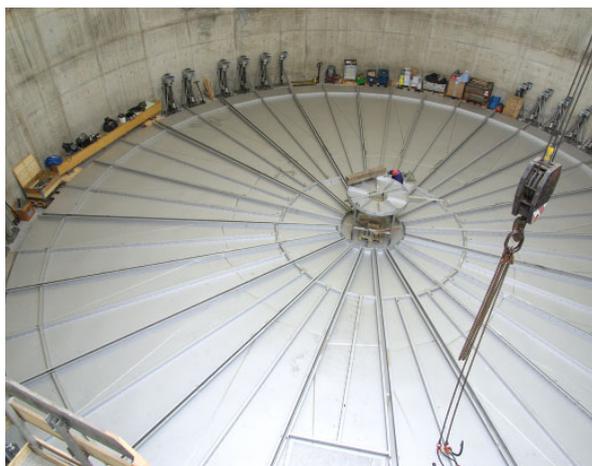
Zusammenbau des Segmentdaches vor Ort. (alle Fotos Hydro-Elektrik GmbH)
